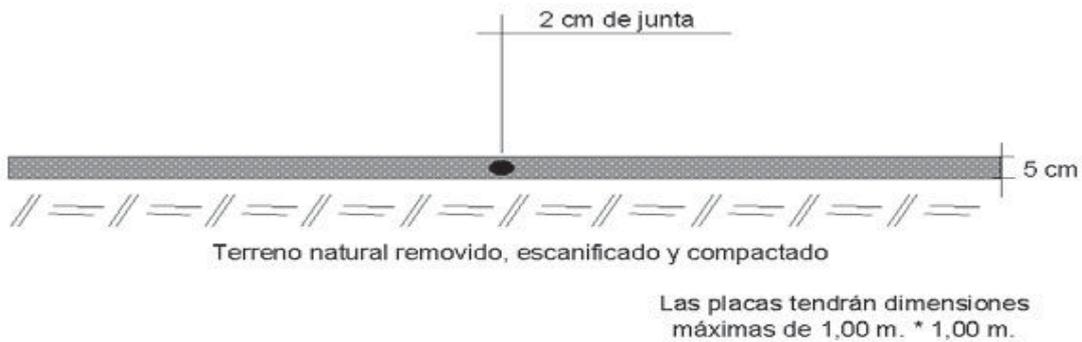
Pavimento en concreto hidráulico con placas prefabricadas.
